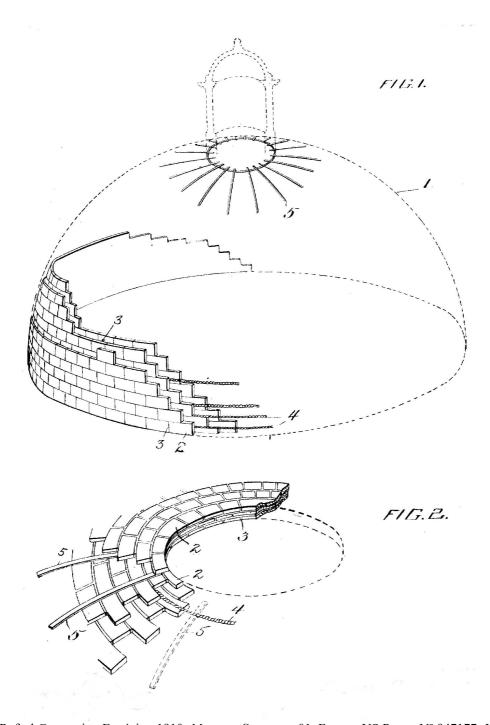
Rafael Guastavino Expósito, 1910. *Masonry Structure*, 01. Fuente: US Patent Nº 947177, January, 1910.
